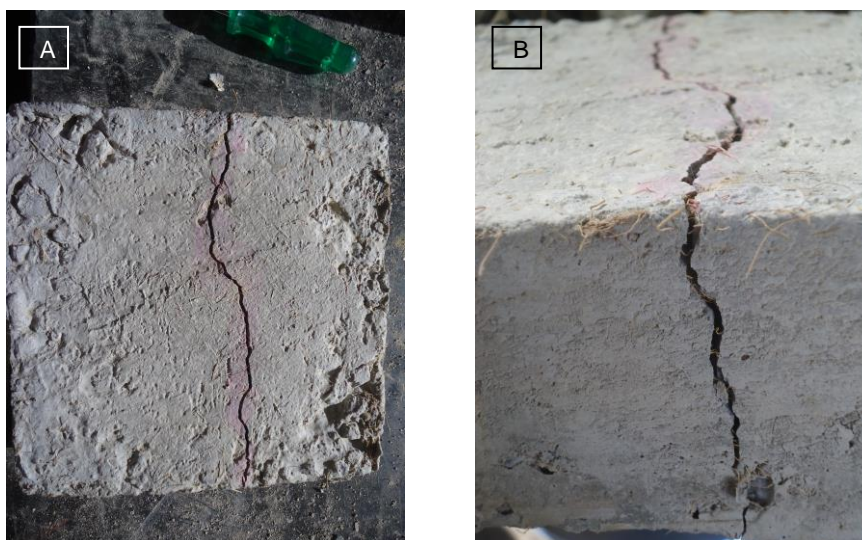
IMAGEM DE CP DE CONCRETO COM 0,8% FC APÓS ENSAIO DE IMPACTO, APRESENTANDO FISSURA DE 1,0 MM: (A) VISTA SUPERIOR; (B) DETALHE LATERAL DA FISSURA
